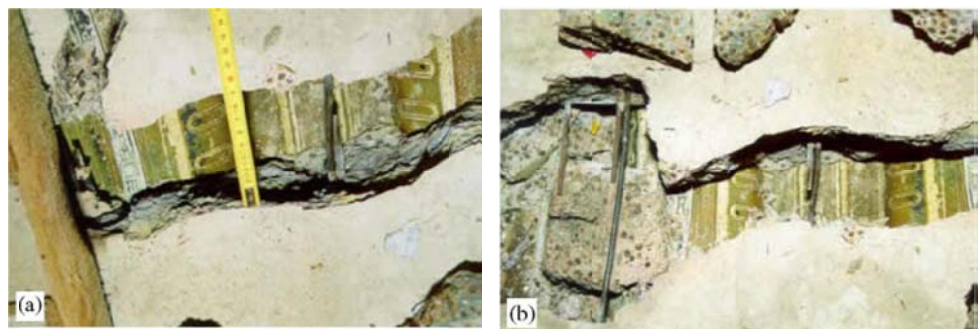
Dalle de plancher fissurée autour d'une tête de colonne
